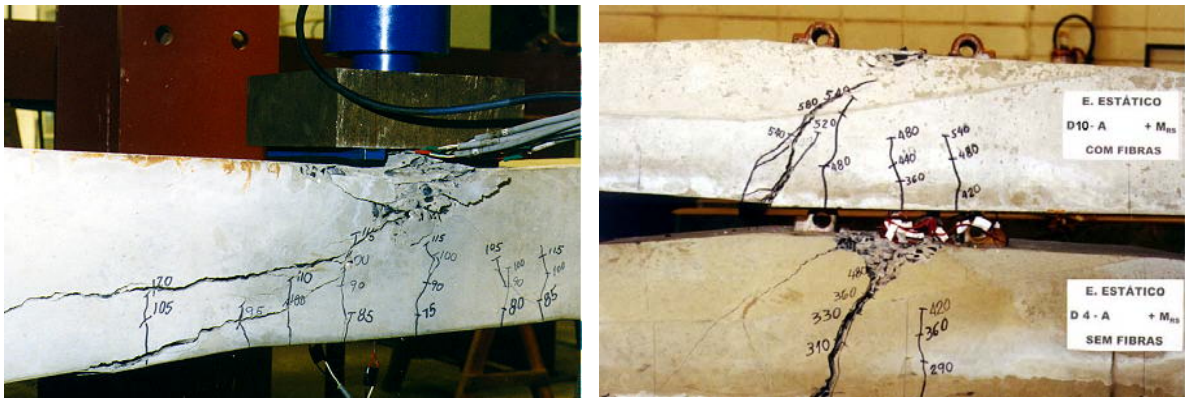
Fissuras de flexão num dormente ferroviário de concreto protendido.
